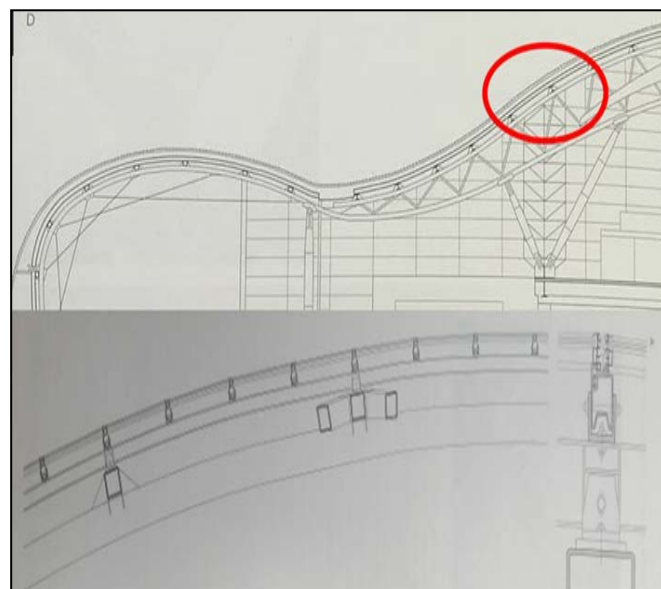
assemblage de poutre triangulée avec la toiture ondulé
